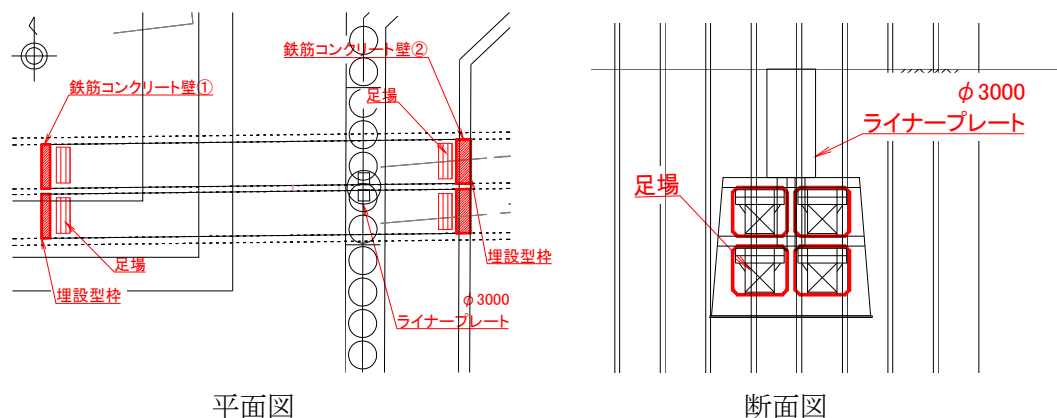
鉄筋コンクリート壁設置工計画図
